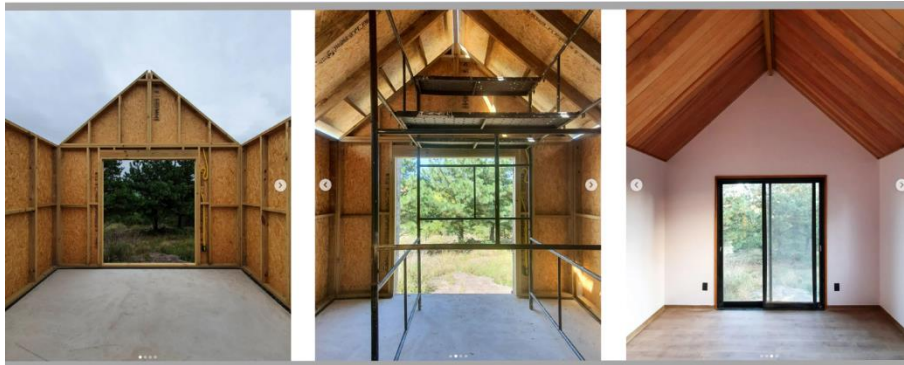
Construção de uma cabana da Empresa C no canteiro de obras
